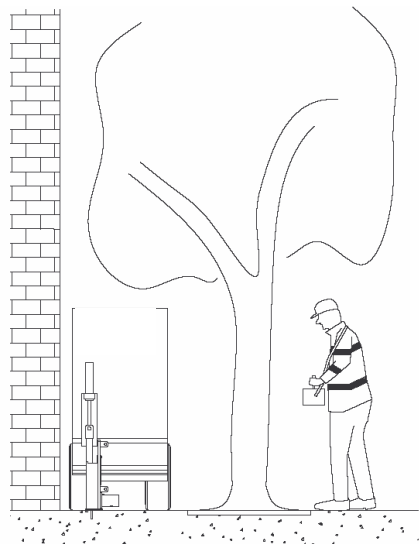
schéma technique et vue de la machine de micro tranchage sous trottoir
